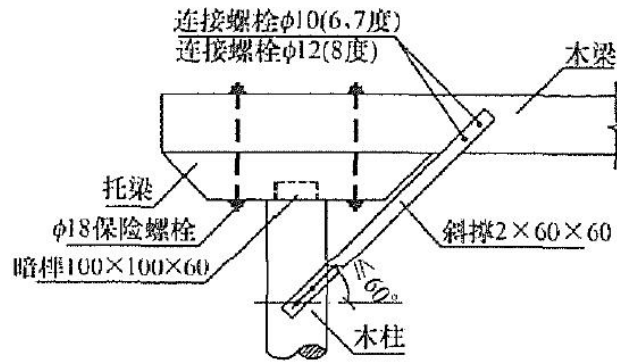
屋架加设斜撑图（单位：mm）
